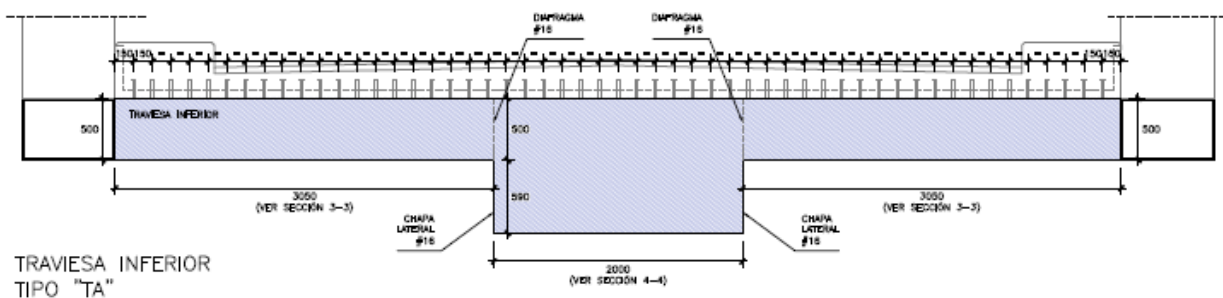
Traviesa metálica en zona de apoyo con tope sísmico transversal
